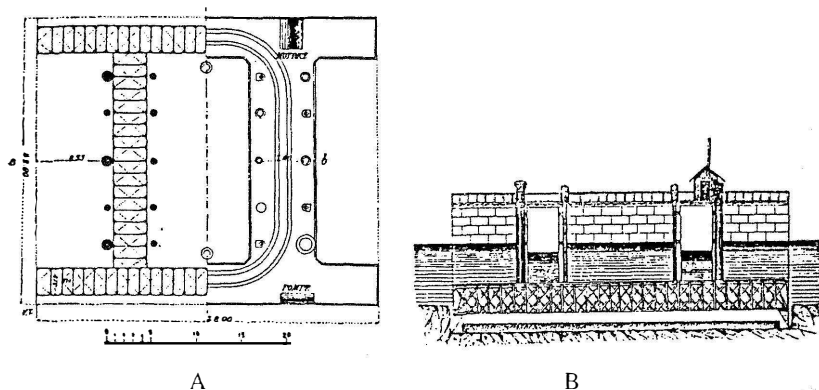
A: pianta del cassone galleggiante; B: sezione del cassone galleggiante.
